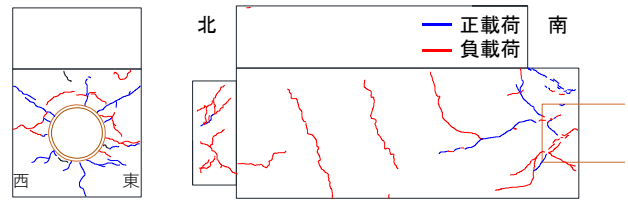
にひび割れ状況、写真-1に最終破壊状況を示す。ひび割れ状況は最後にひび割れ観測をした代表変形角 $R=-1.5\%$ 時のものを示している。ひび割れ観測はパイルキャップに杭が取り付く南面(以下、パイルキャップ底面)とパイルキャップ西面で行った。青線が正載荷時、赤線が負載荷時に発生したひび割れ、黒線は初期ひび割れを示している。
